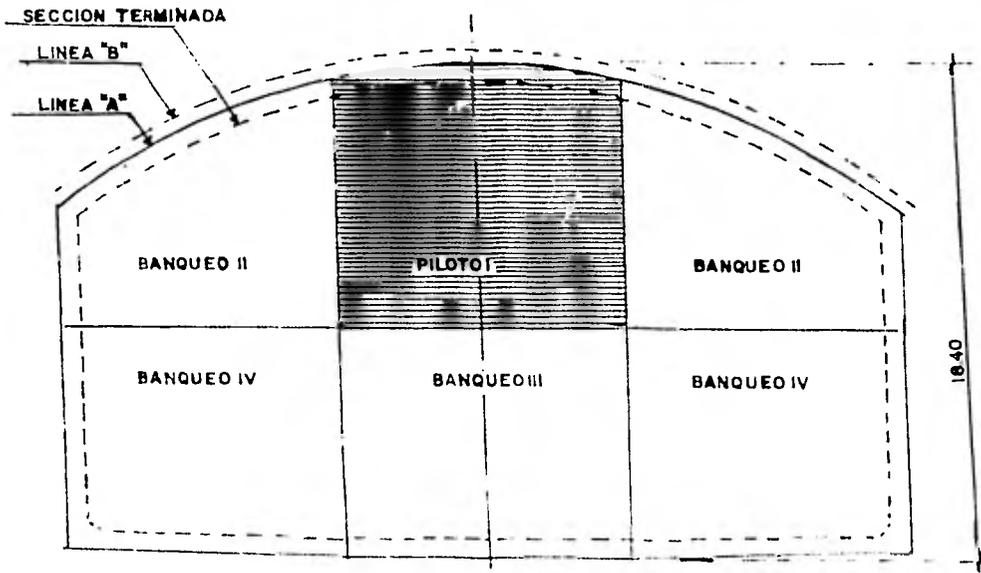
A SECCION DE TRANSICION ETAPAS DE EXCAVACION
